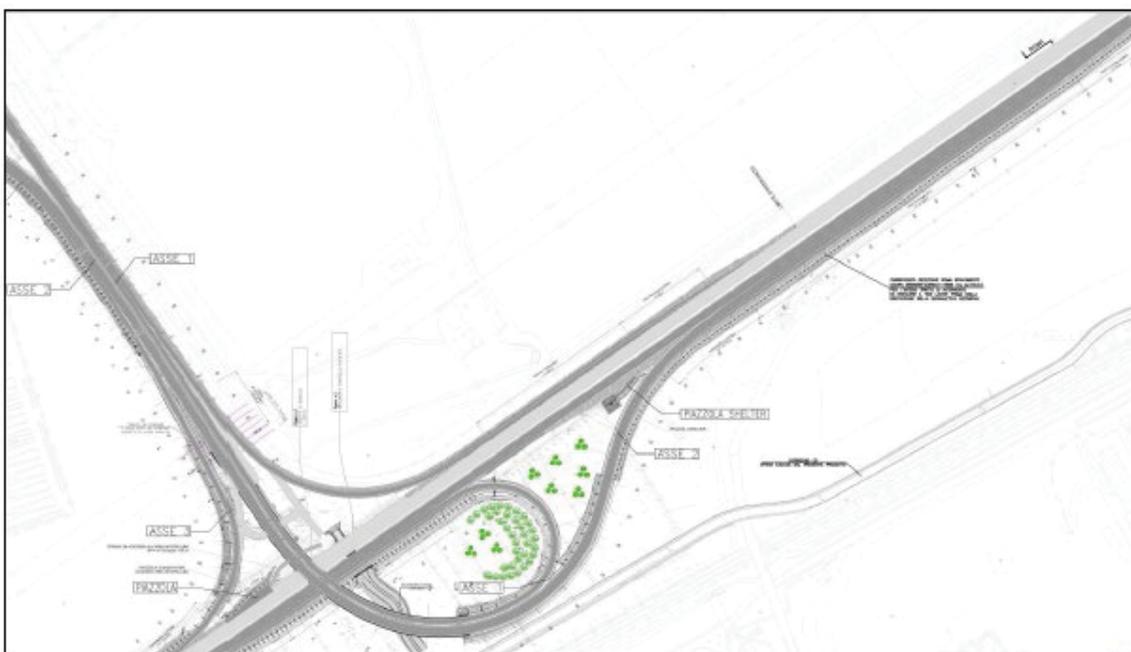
Planimetria di Progetto – Nuova geometrizzazione della rampa Cargo City – Roma
